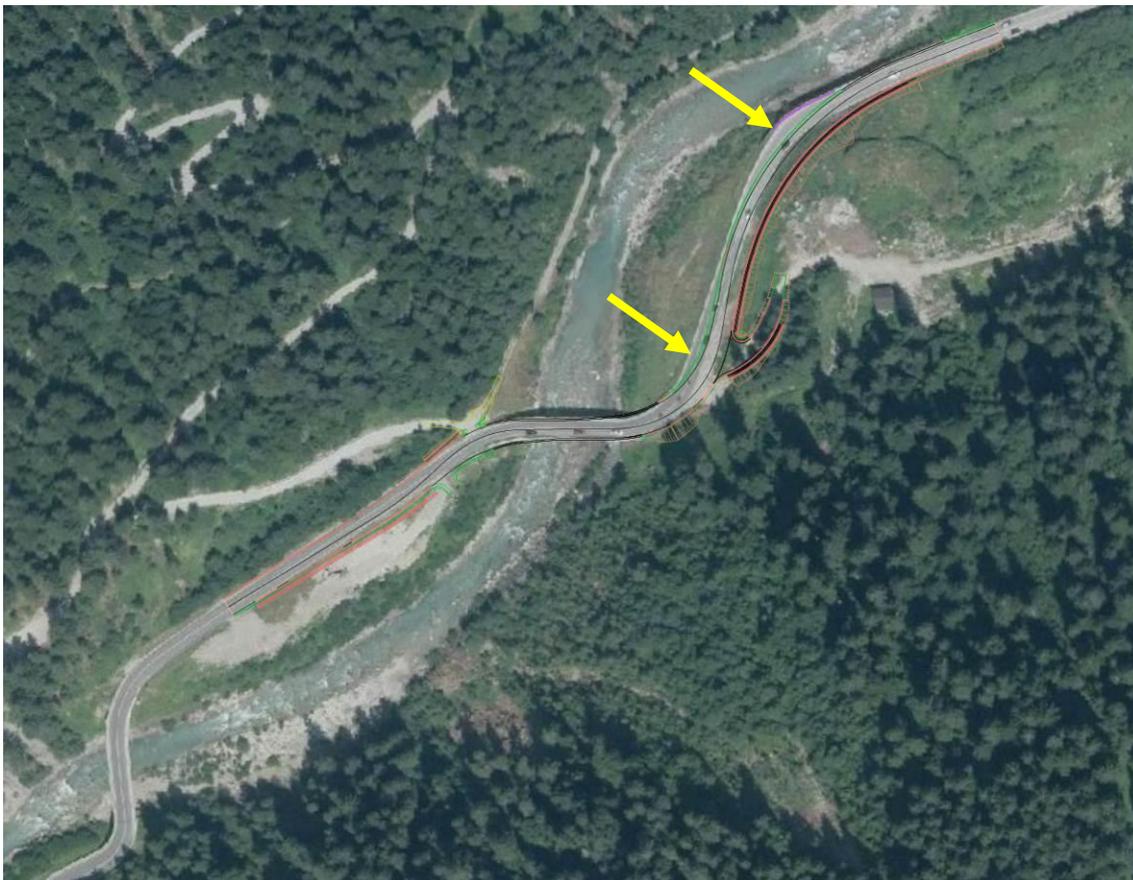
Inserimento complessivo dell'intervento su ortofoto.
